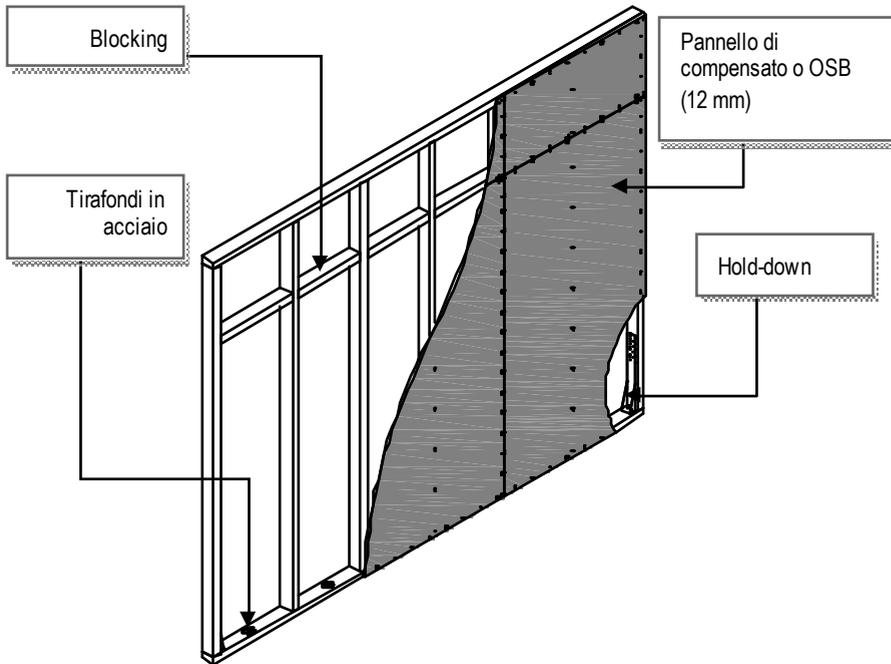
Dettaglio strutturale di una parete Platform con collegamento del pannello strutturale di compensato/OSB tramite chiodi e elementi di collegamento alla fondazione.
